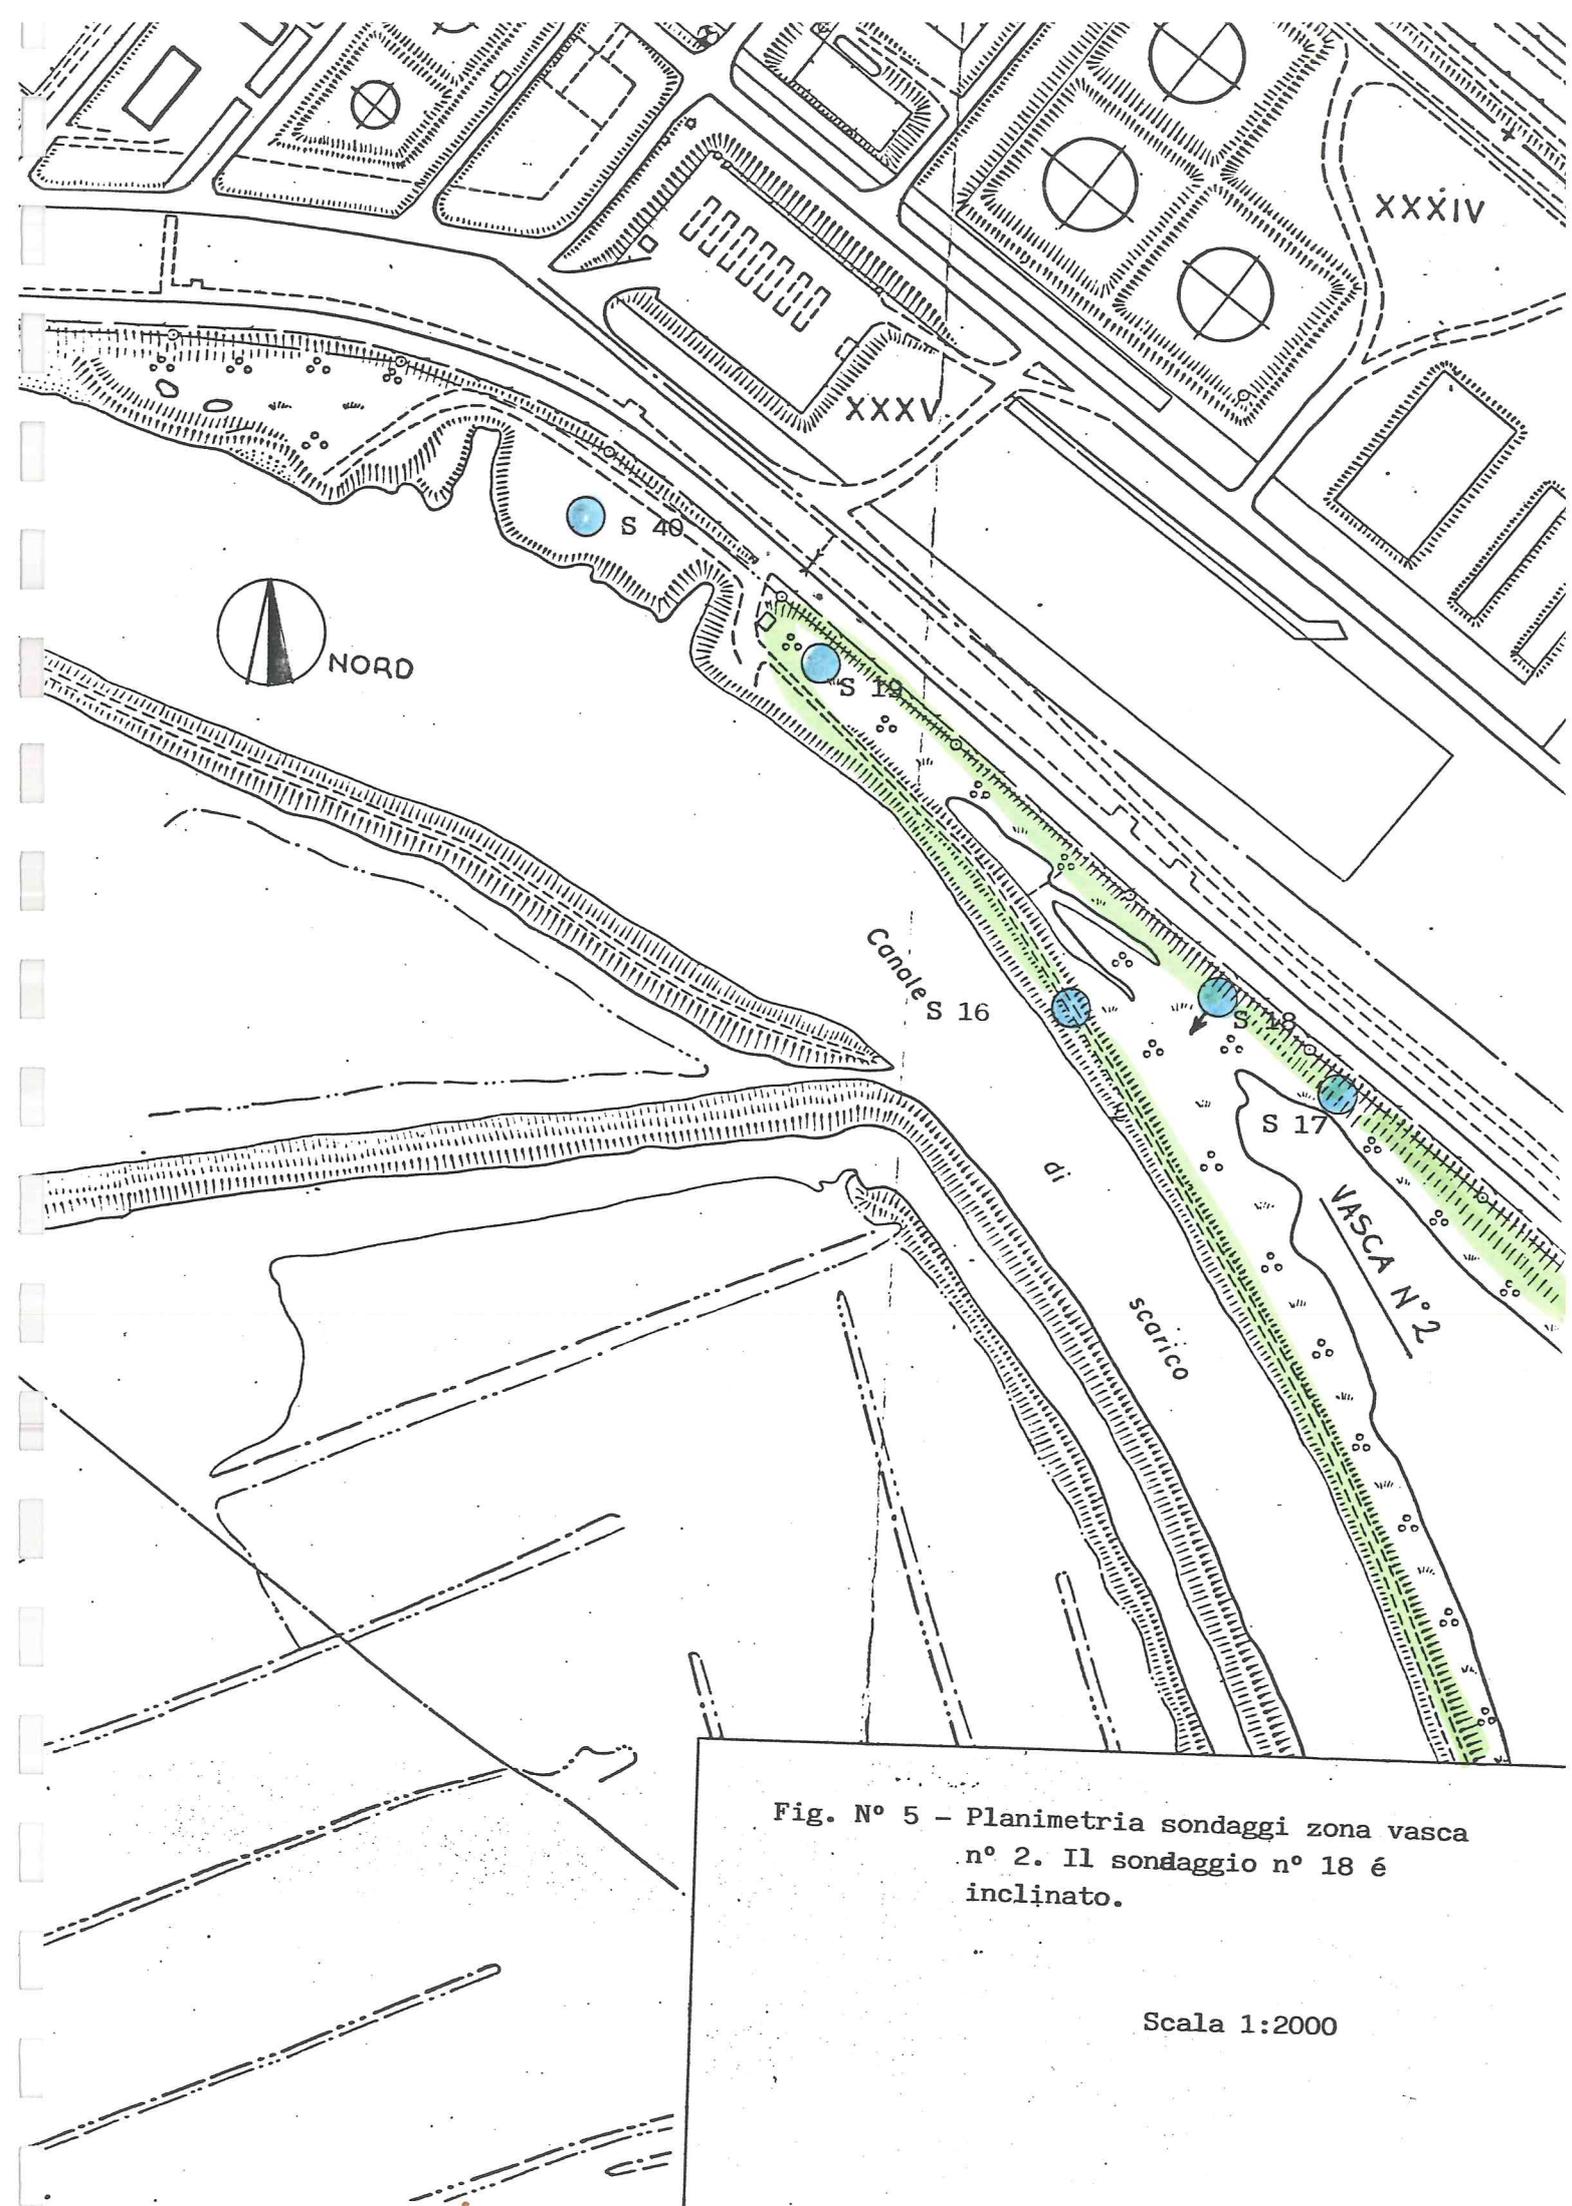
Planimetria sondaggi zona vasca n° 2. Il sondaggio n° 18 é inclinato.
